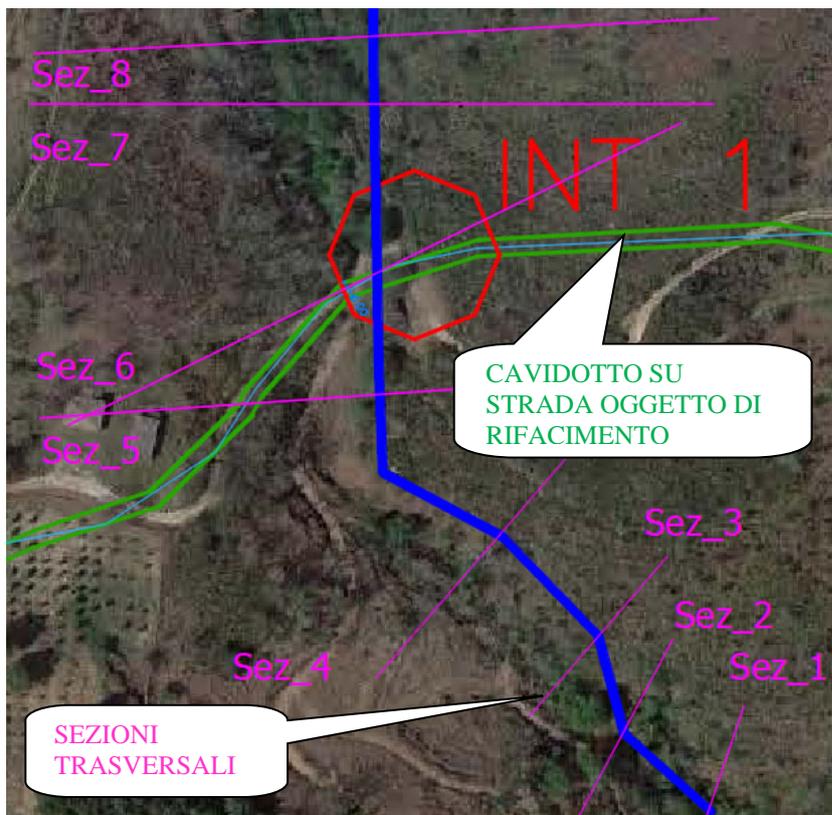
Planimetria con indicazione delle sezioni in dwg su base ortofoto.
